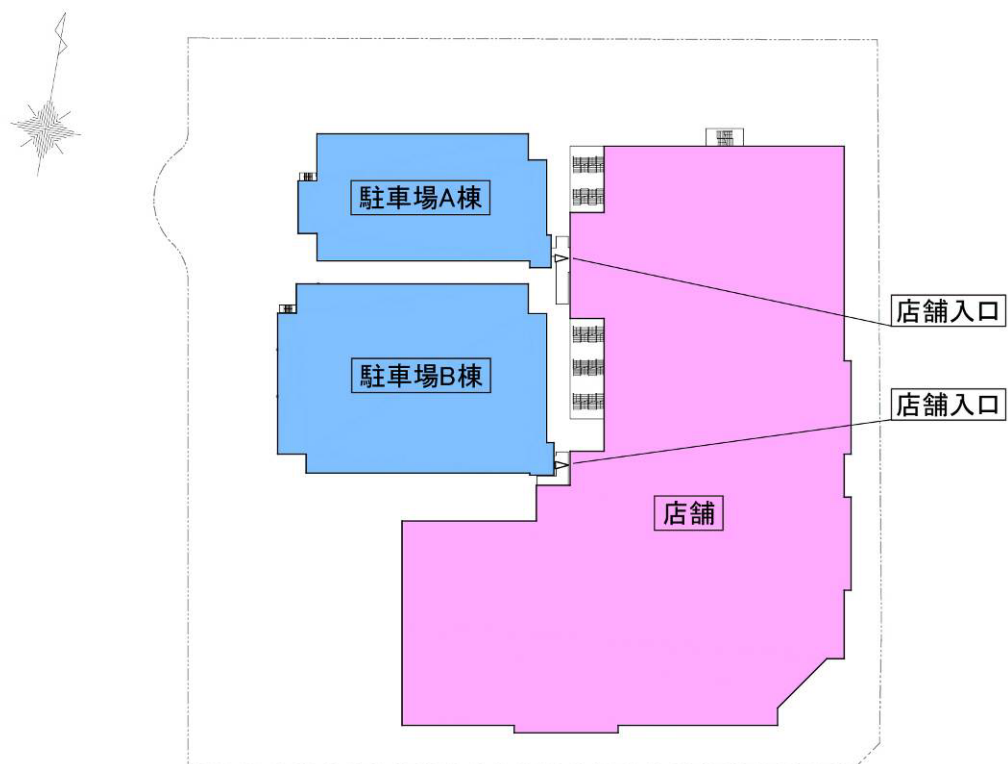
(3) 各階平面図(商業棟 3 階, 駐車場 A 棟 4 階, 駐車場 B 棟 4 階) 【変更後】
